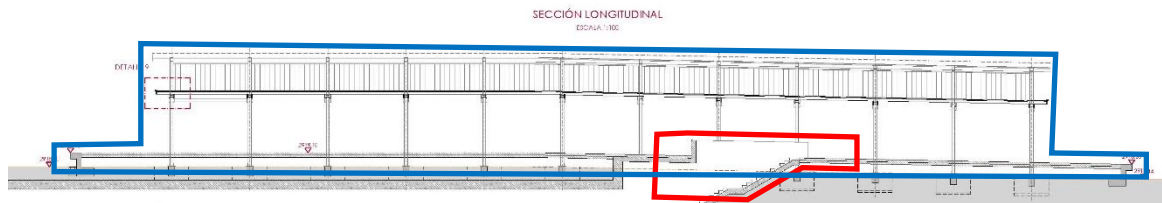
Sección longitudinal acceso 4 (rojo EPMMQ, azul EPMPQ).
